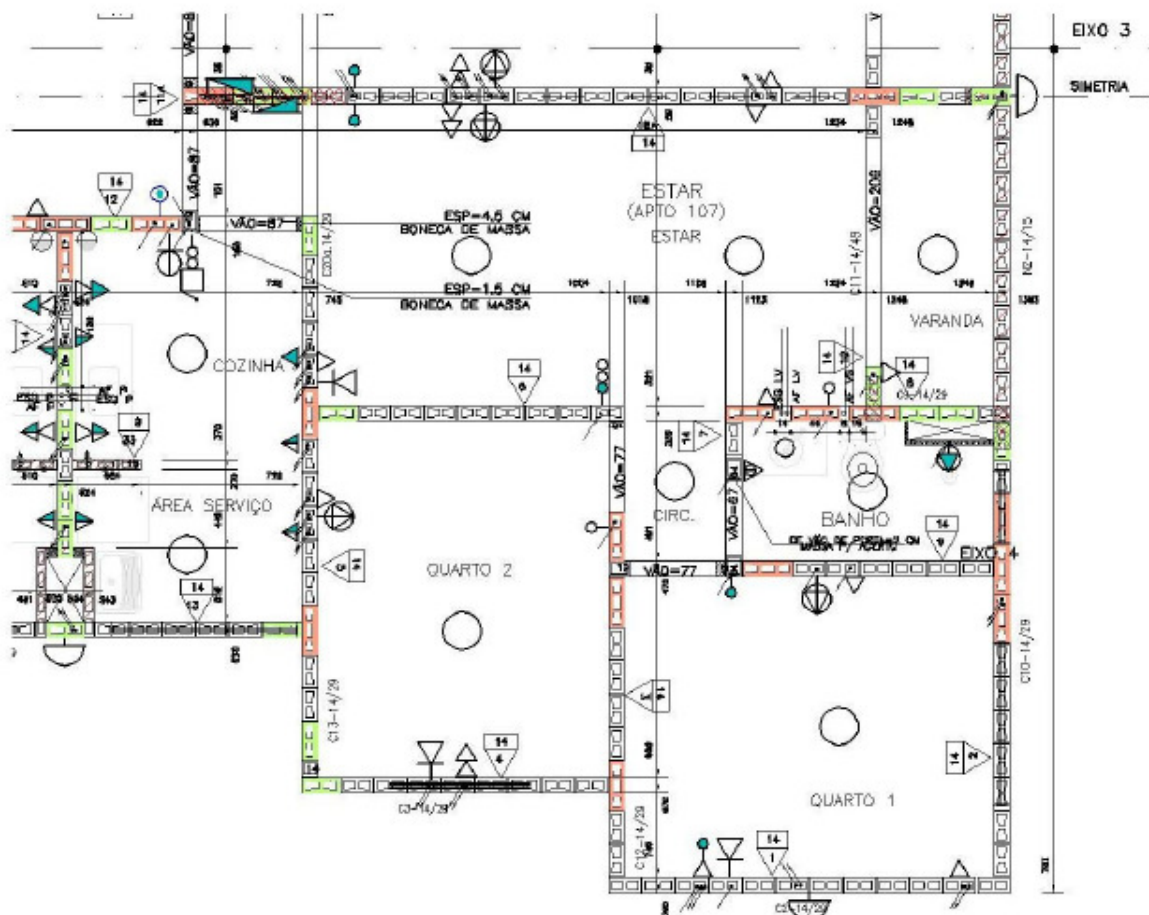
Projeto de Modulação – Planta de 1ª Fiada
